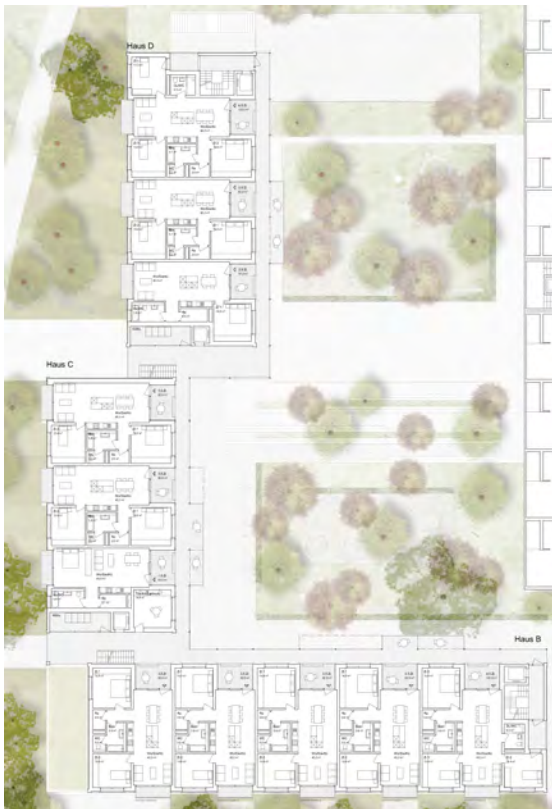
LILY: Grundriss Regelgeschoss Wohnbauten
